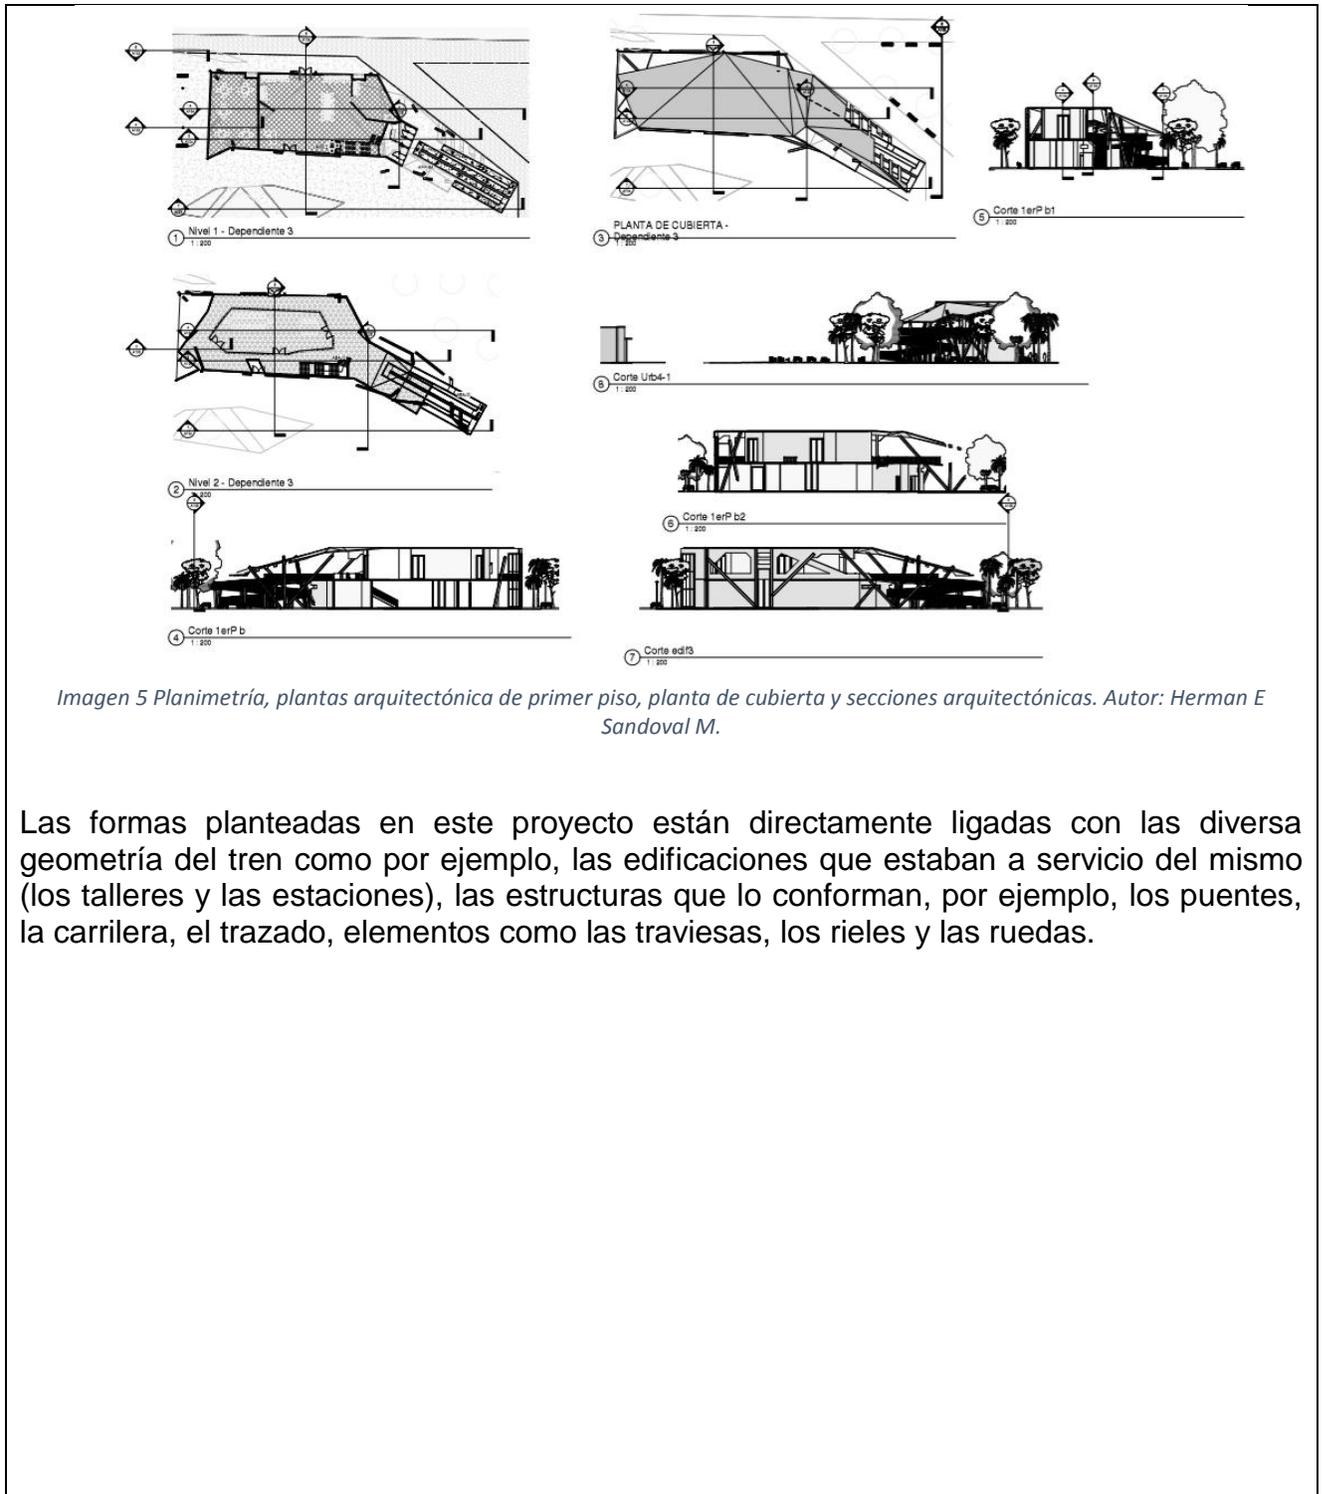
Planimetría, plantas arquitectónica de primer piso, planta de cubierta y secciones arquitectónicas. Autor: Herman E Sandoval M.
